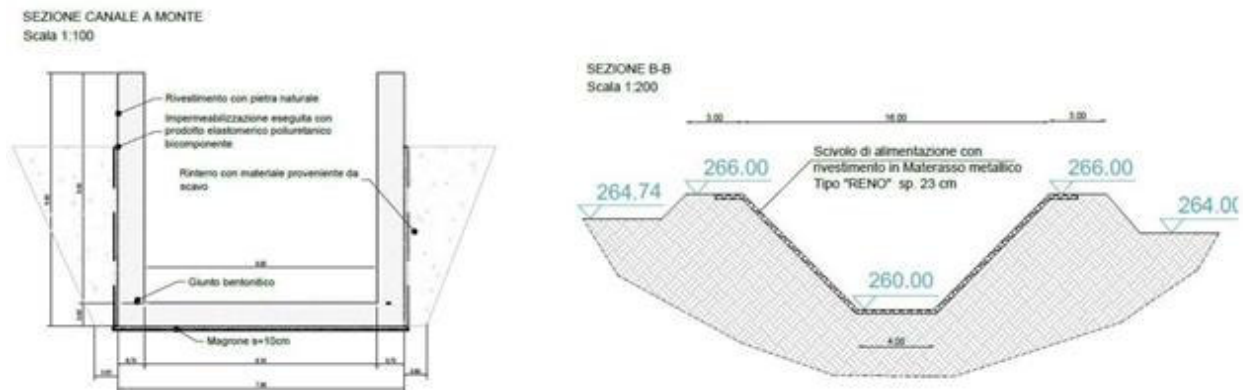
e 9: Sezione canale a monte e sezione scivolo di alimentazione con rivestimento in materasso tipo "Reno".
